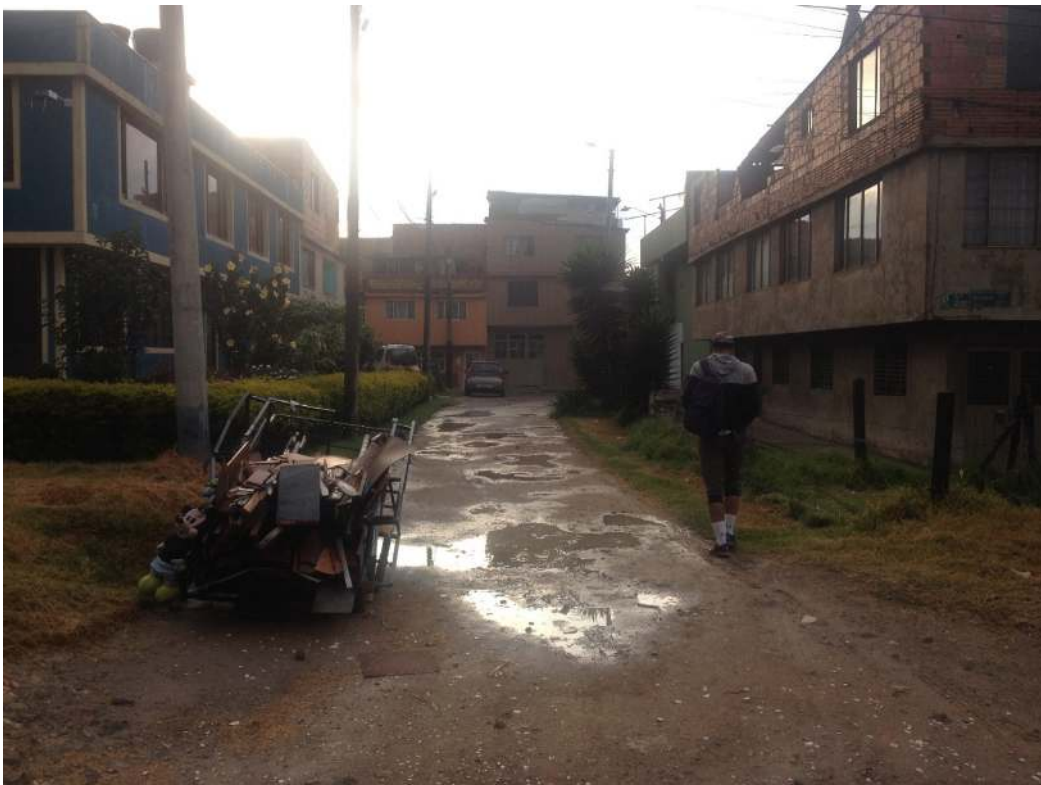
Intersección Avenida Villavicencio KR 71 B Calle 53A Bis Sur
